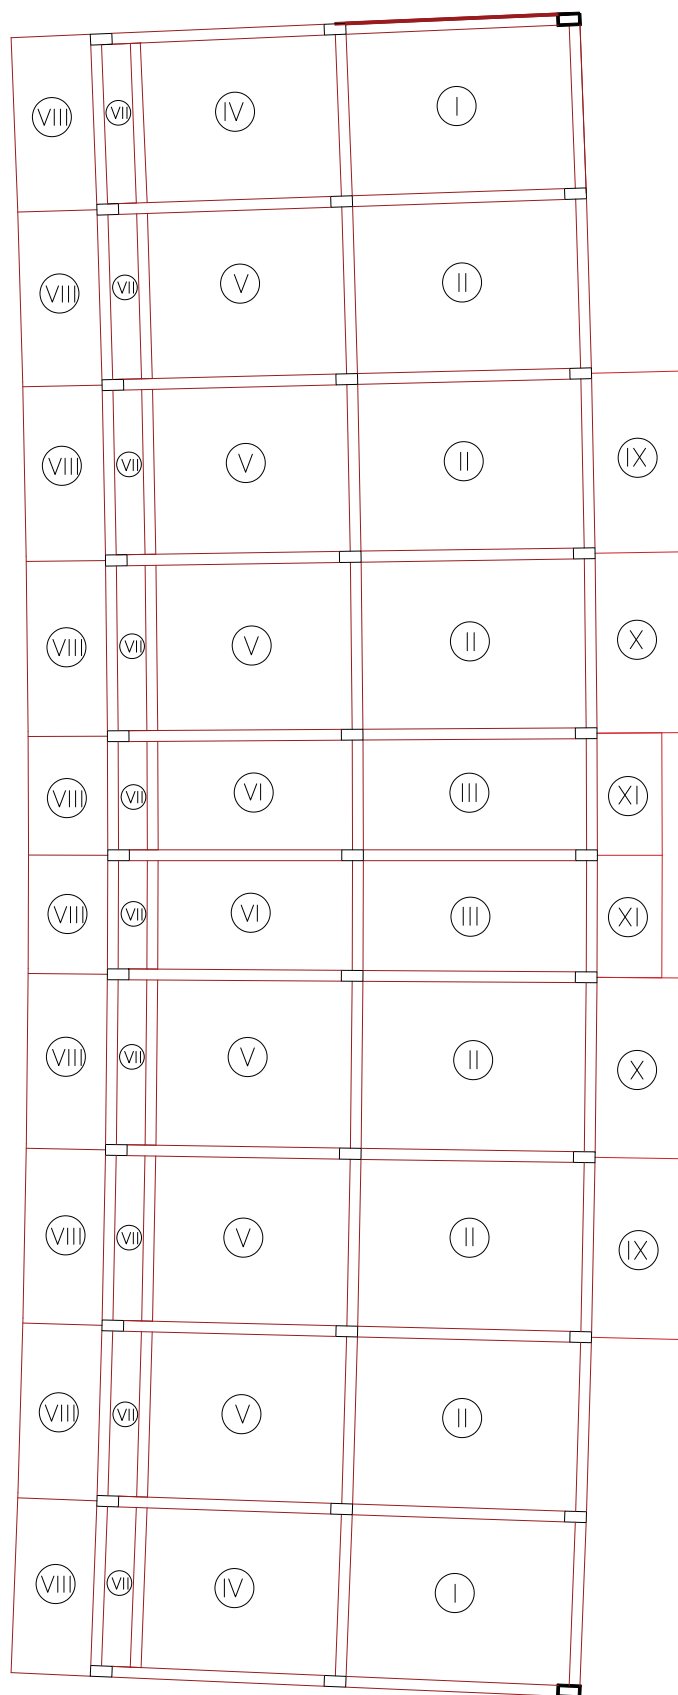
Distribución en Planta de Paños de Losas – Bloque C
